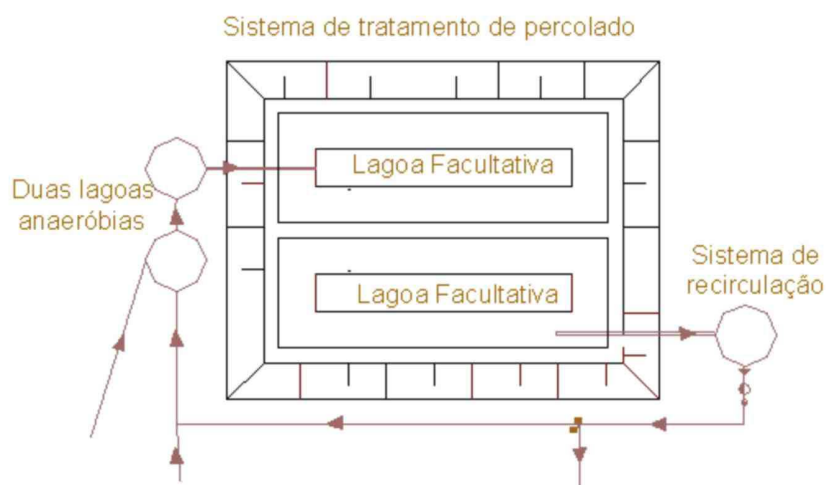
Esquema da Planta Baixa do Sistema de Tratamento de Percolado.
